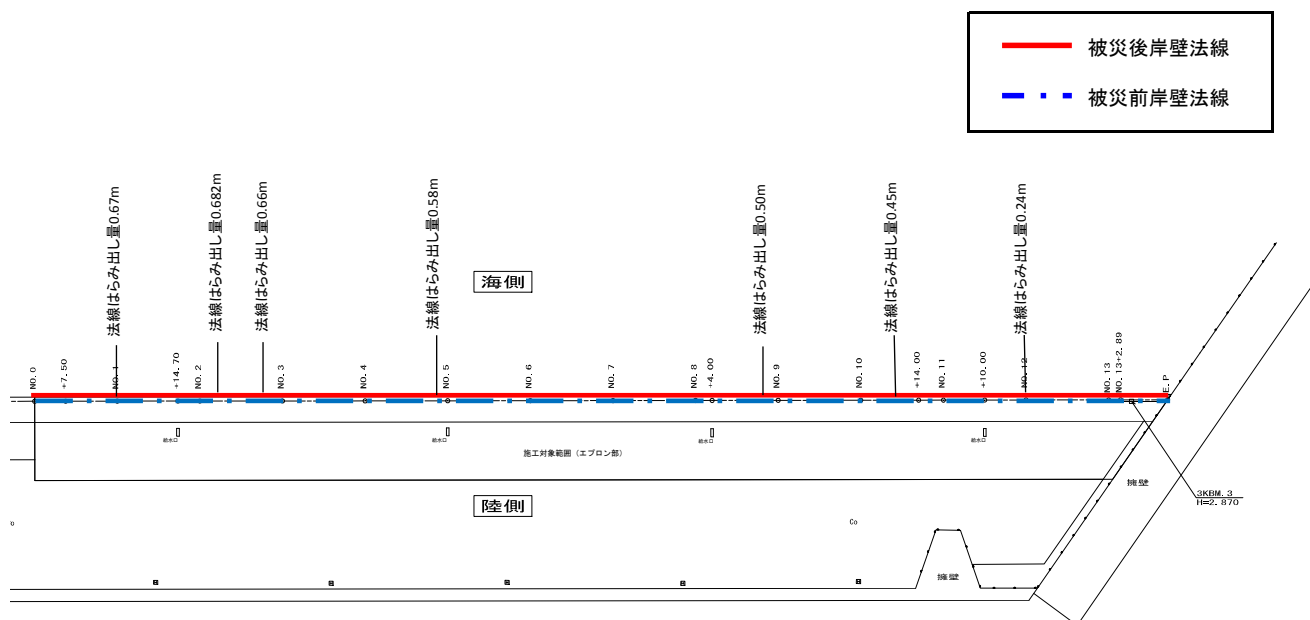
No.23 常陸那珂港区\_南ふ頭地区 C 岸壁 (-7.5m) の平面図 (被災後)
